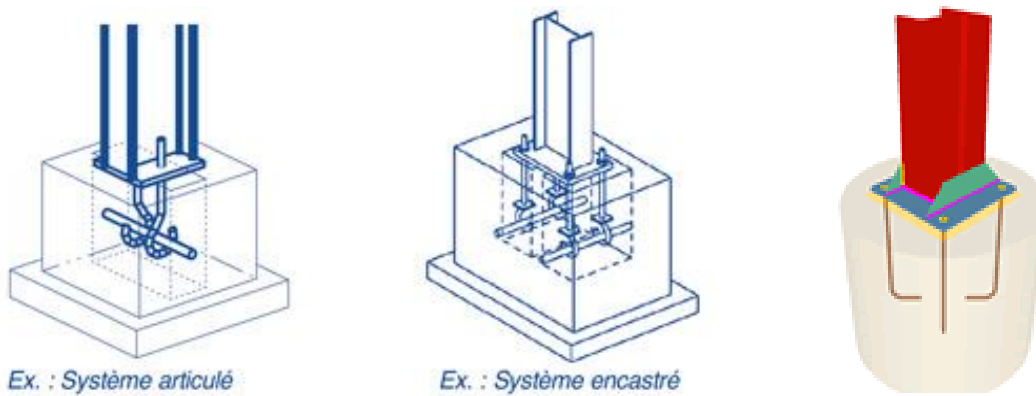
Exemple de poteau métallique avec fondation en béton armé
